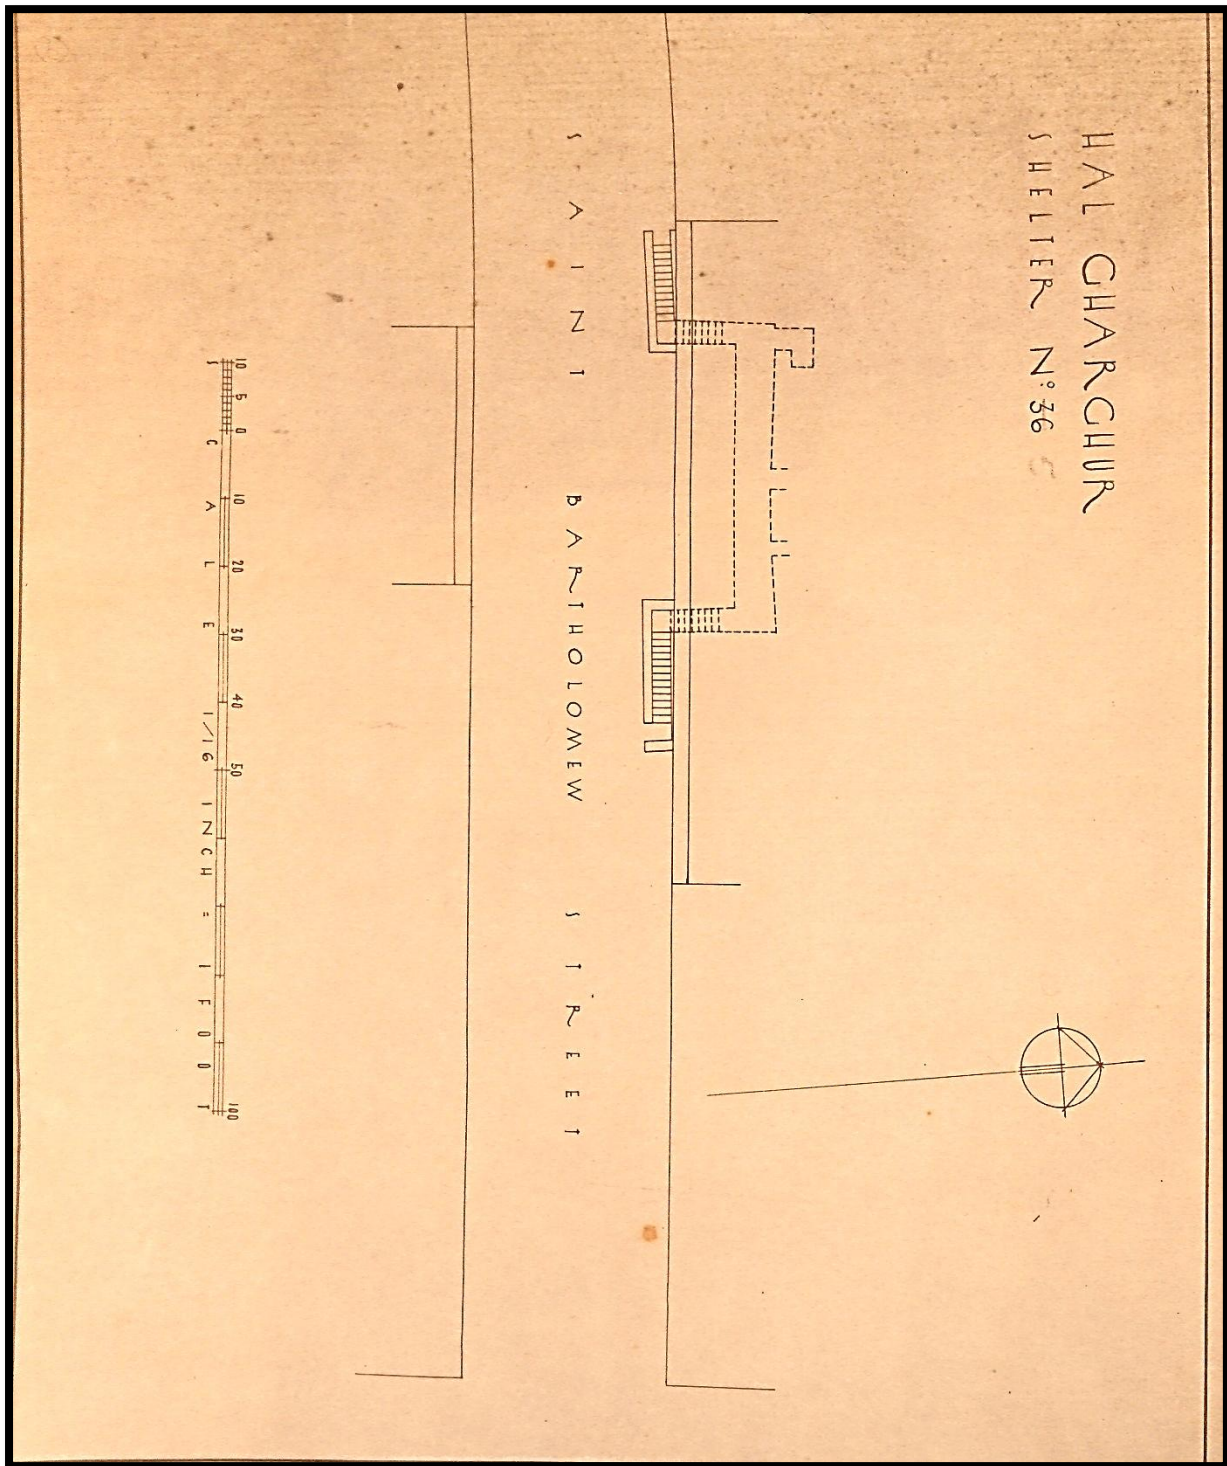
Planta do Abrigo nº36 (5) "Saint Bartholomew Street"
